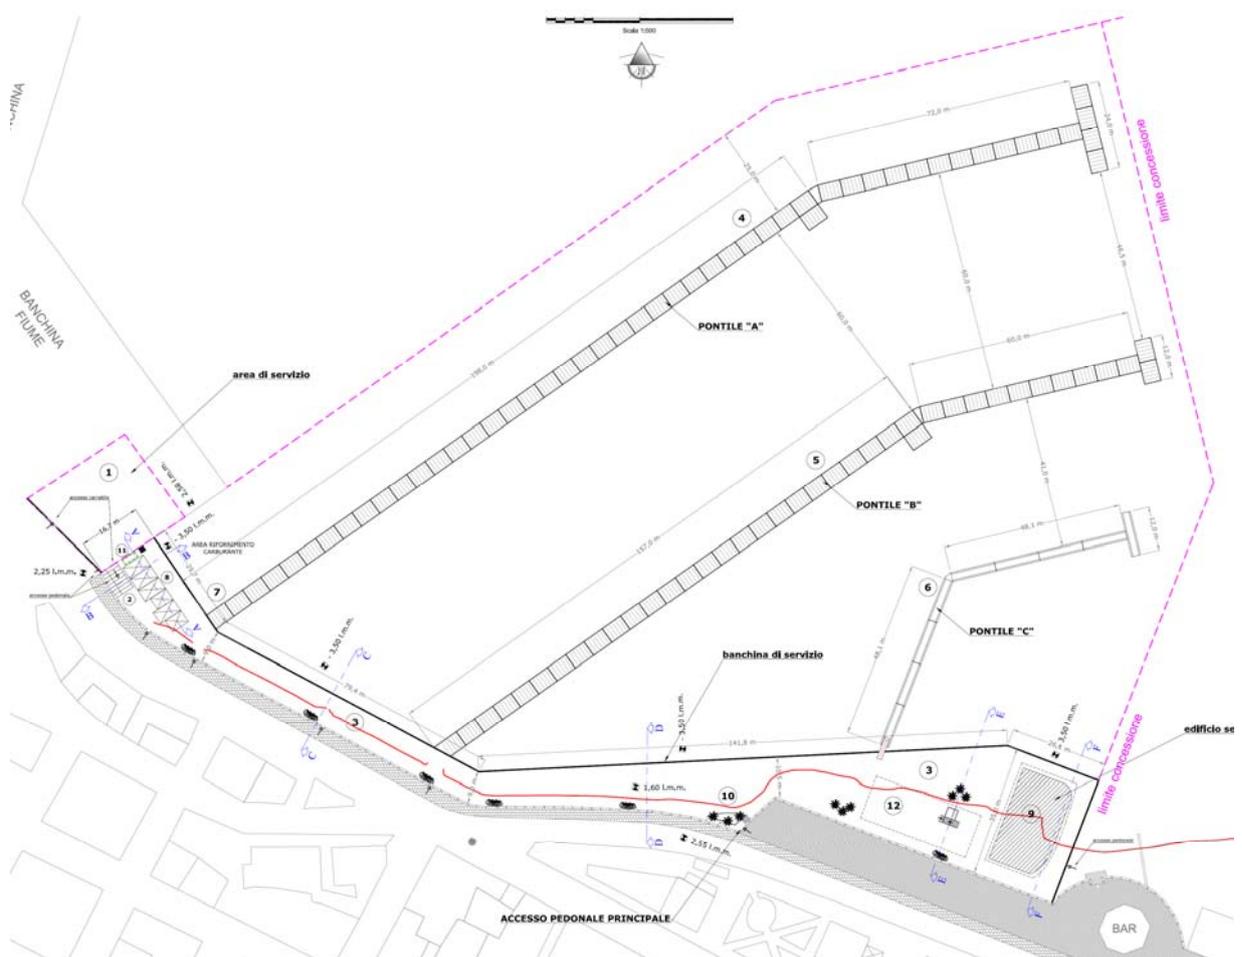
Planimetria di progetto (Tavola T3)
